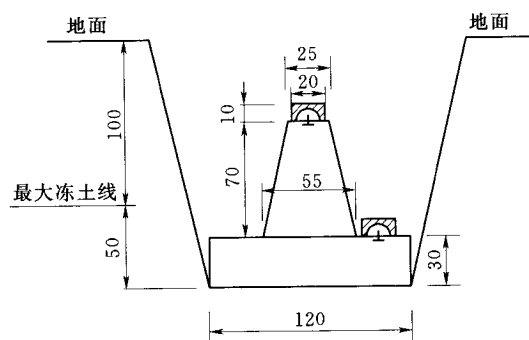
1 混凝土基本水准标石埋设图 (单位: cm)
